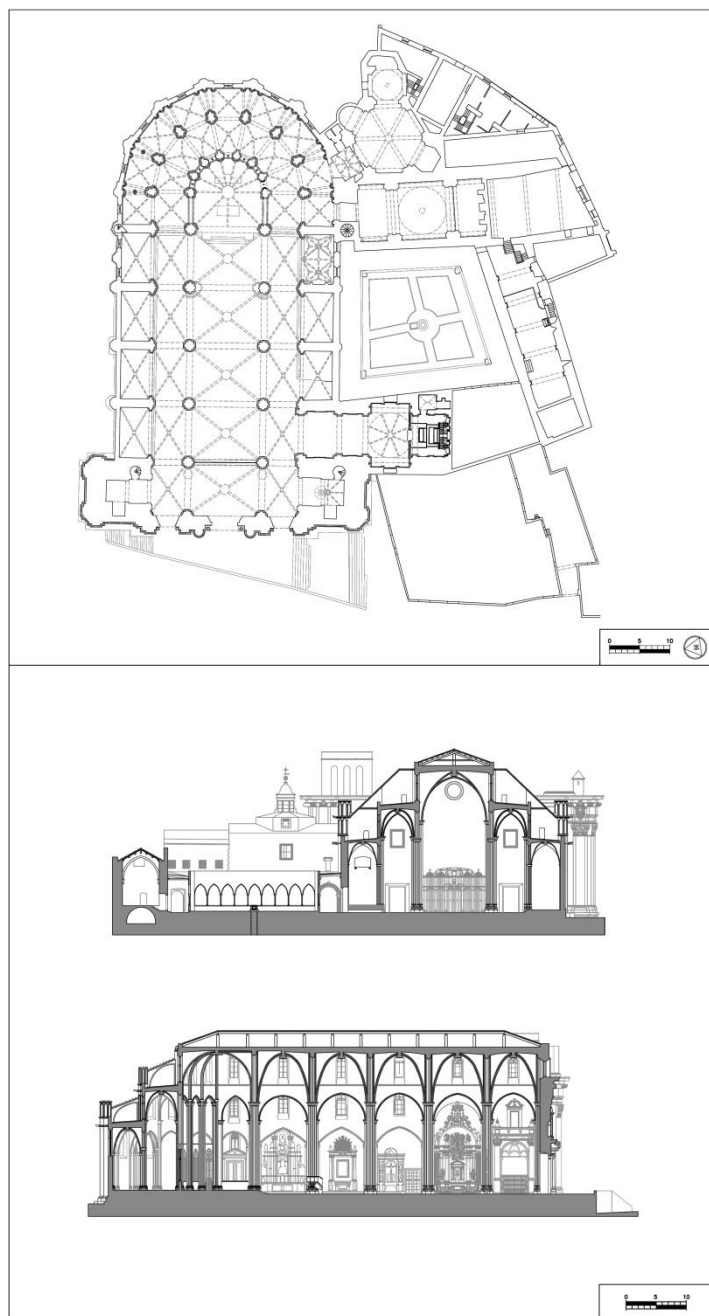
Planta baja (n2) y secciones del Plan Director (Lluís y Llorca, 2000).
